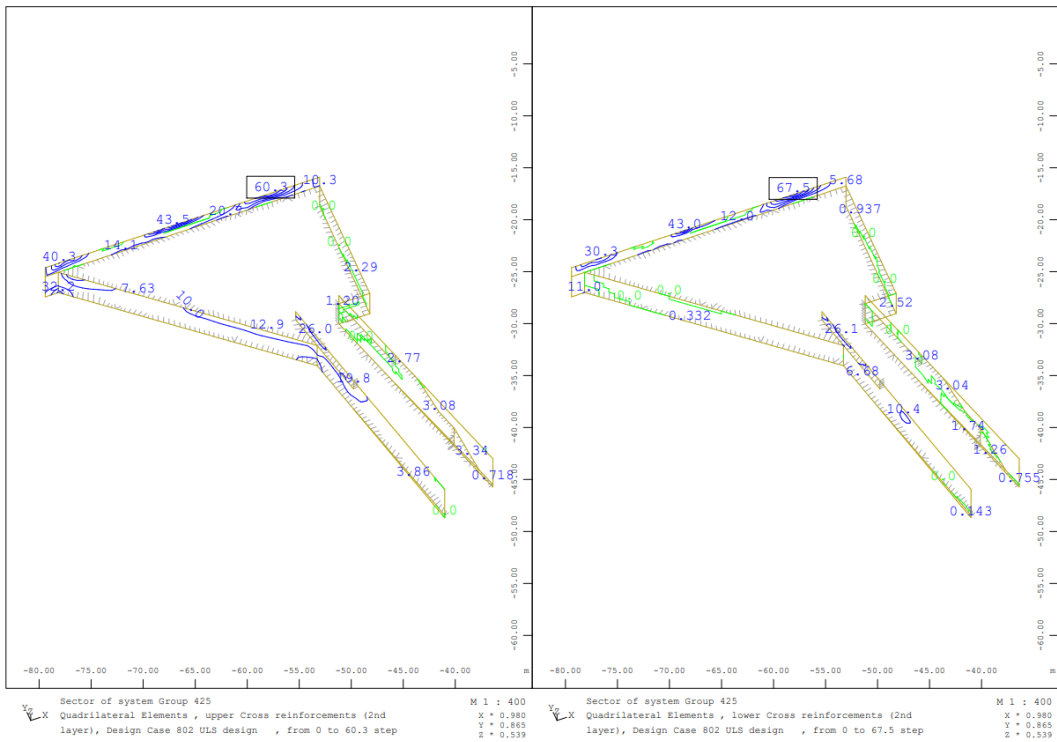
Armadura horizontal na face exterior (esq.) e interior (dir.) – muros – acesso Sul - ELU
